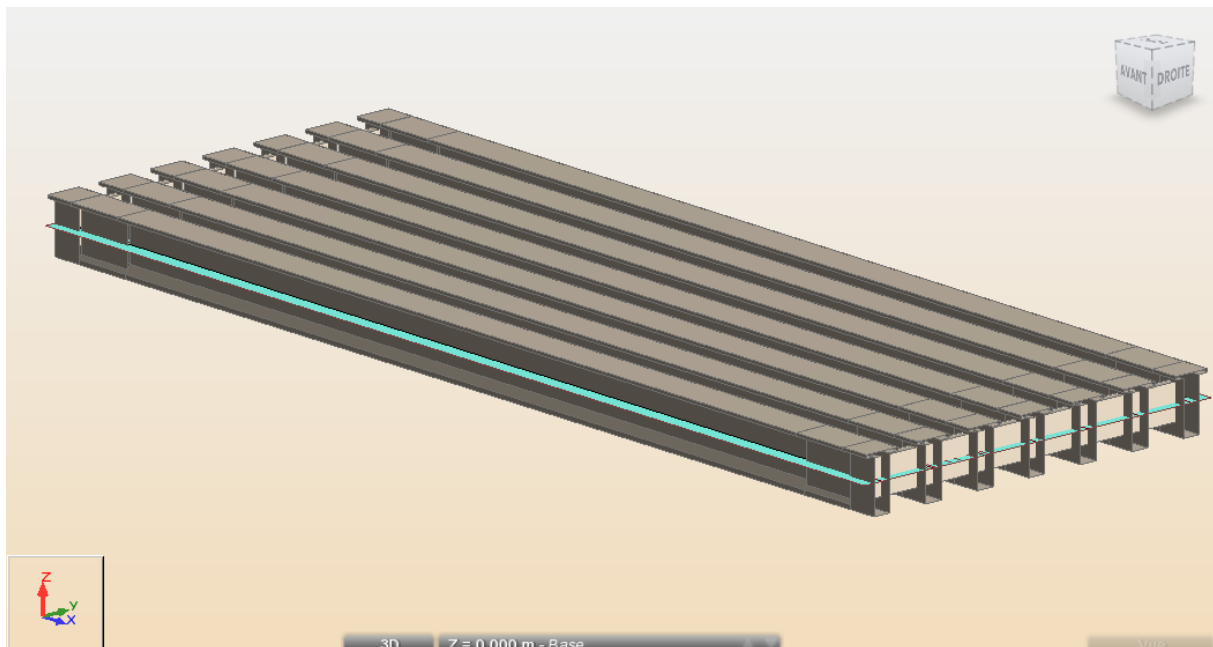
Les 7 poutres et l'hourdis qui constituent le tablier
